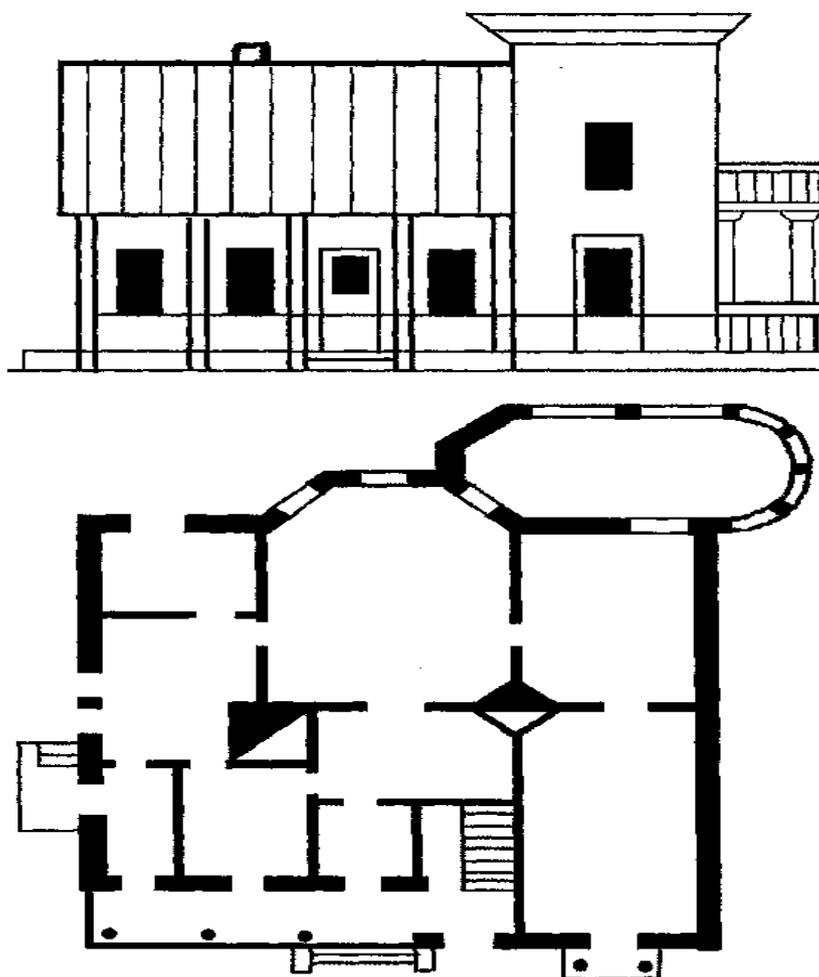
Проект одноквартирного сельского жилого дома с эркером, террасой и верандой. 1934 г. Фасад, план
